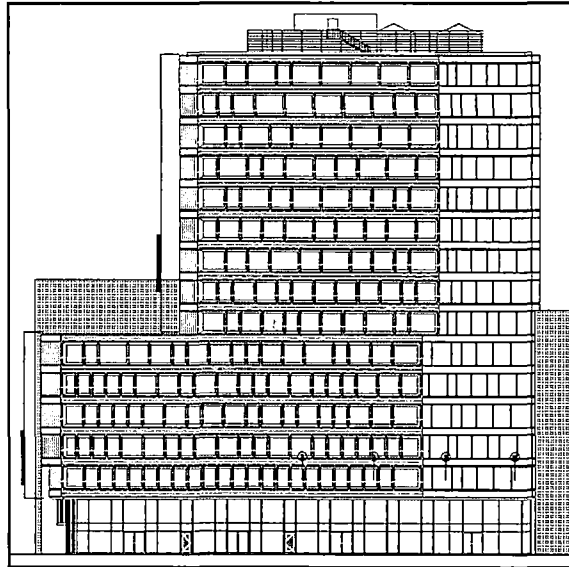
Vista elevación de la fachada sur. Obra: Real 8
